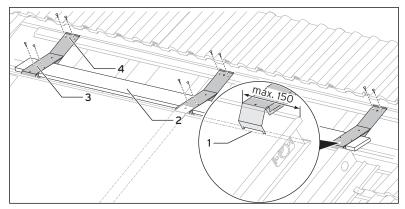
Colocar los empalmes de la plancha del tejado inferior (colector vertical)
